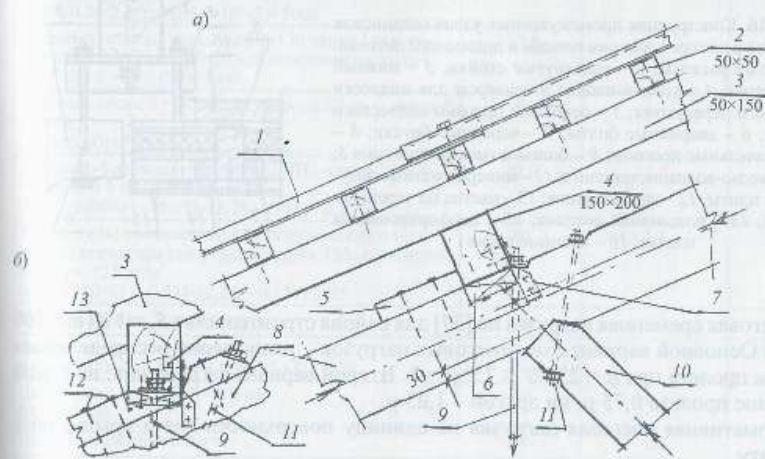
Конструкция промежуточного узла соединения элементов решетки и верхнего пояса: а - вариант непосредственного опирания прогона на верхний пояс; б - вариант передачи усилий от стойки 9 и прогона 4 через подкладку 13: 1 - асбестоцементные волнистые листы; 2 - обрешетка из брусков 50x50 через 20 см; 3 - вспомогательные прогоны - стропила через 1 м; 4 - основной узловой прогон; 5 и 6 - деревянные бобышки на гвоздях; 7 - металлическая климера на гвоздях; 8 - верхний пояс фермы; 9 - стойка-гяж; 10 - сжатый раскос; 11 - стяжной «аварийный» болт; 12 - гвозди в два ряда; 13 - деревянная подкладка
